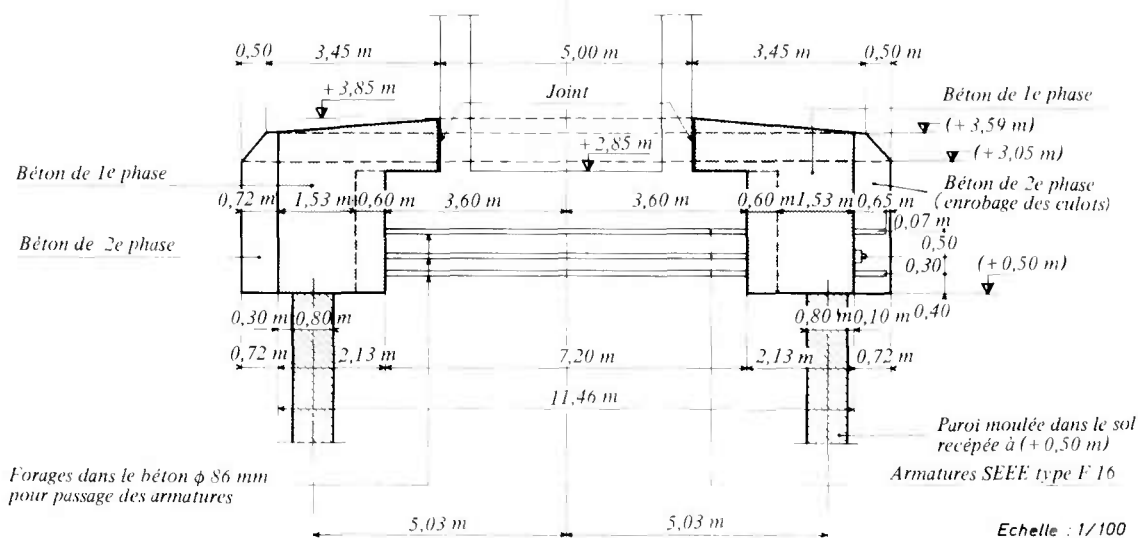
Pont de Beaucaire - Coupe en travers de l'appui conforté - Report des efforts.
